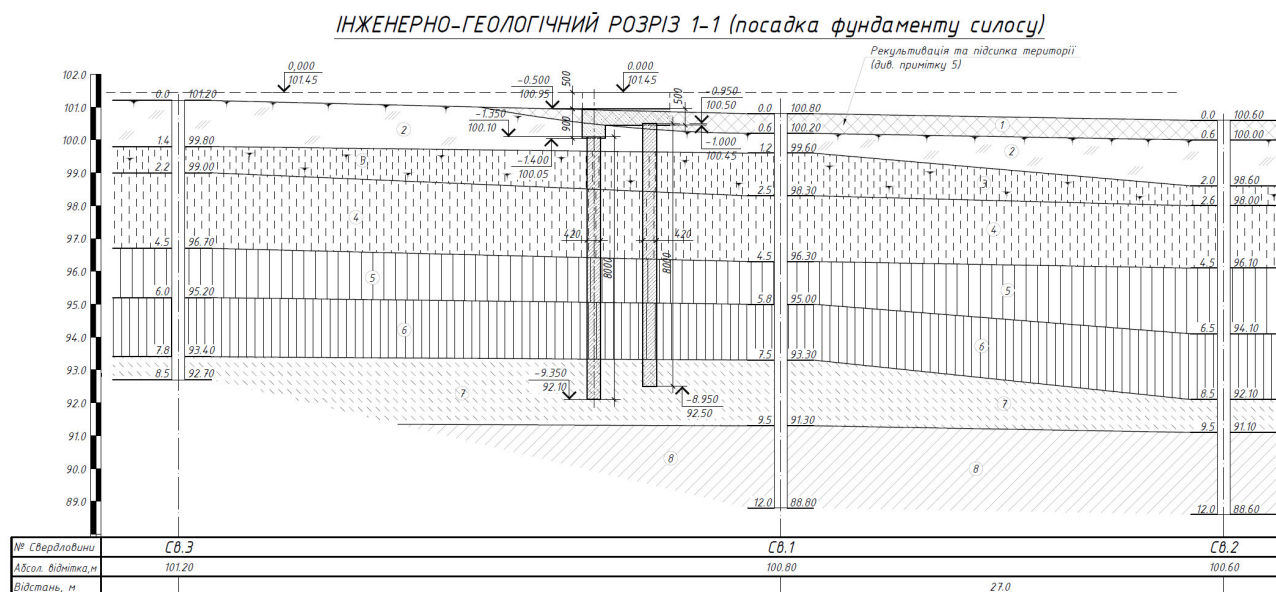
Інженерно-геологічний розріз майданчика будівництва та посадка фундаментів.
